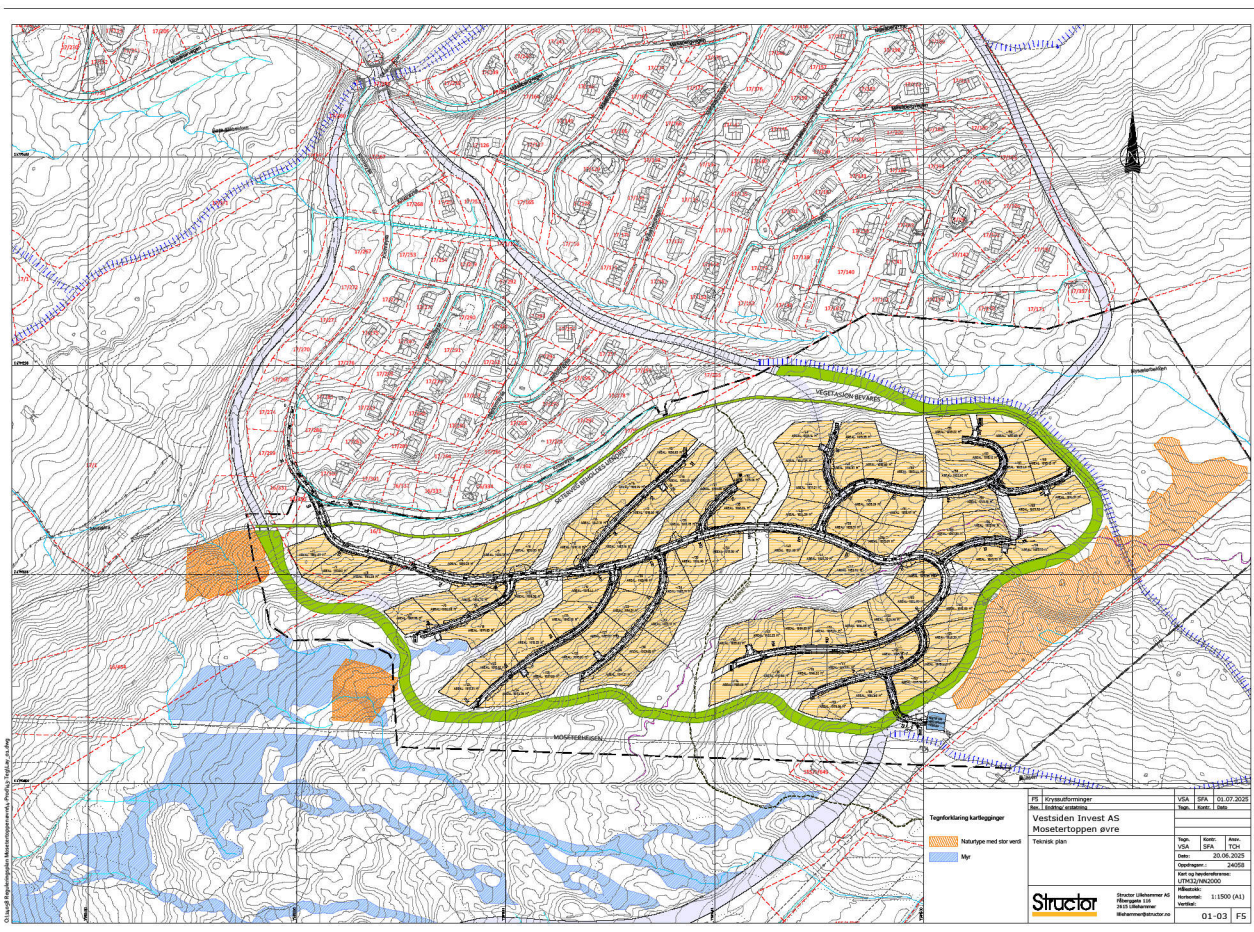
Avgrensning av planområdet, slik det er vist i planprogram (Structor Lillehammer 2025).
